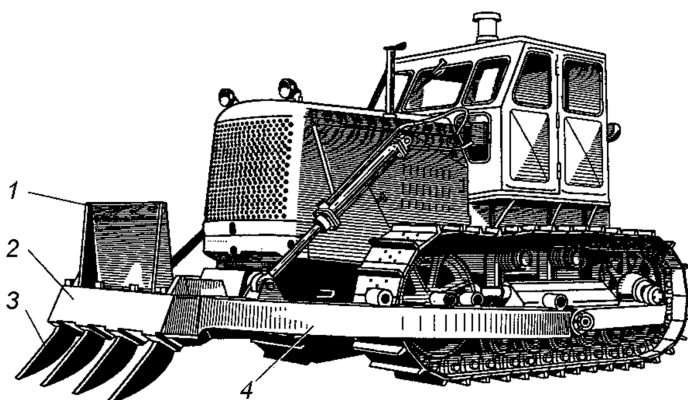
Гусеничный корчеватель–собираатель: 1 – отвал; 2 – рабочая балка; 3 – корчующие зубья; 4 – толкающая рама
